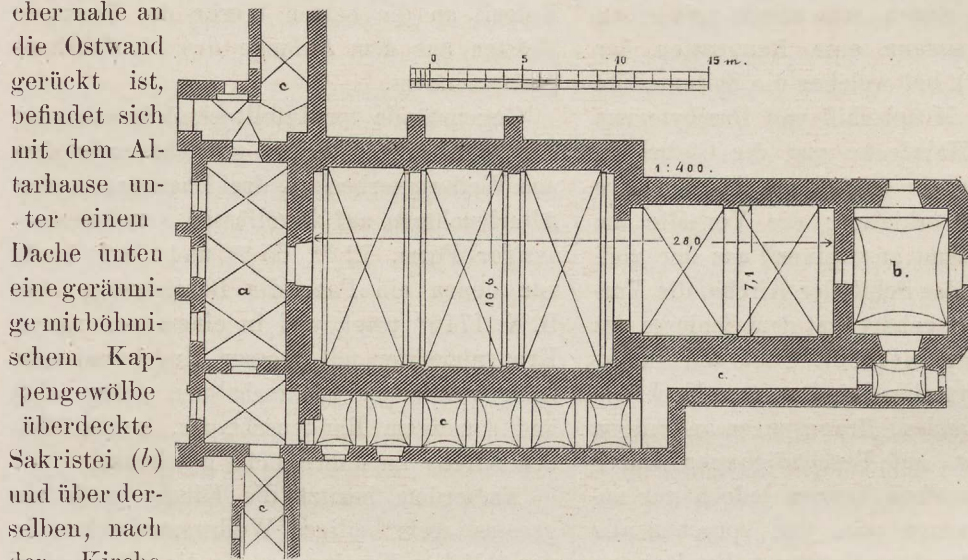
Schwetz. Grundriss der Klosterkirche.
